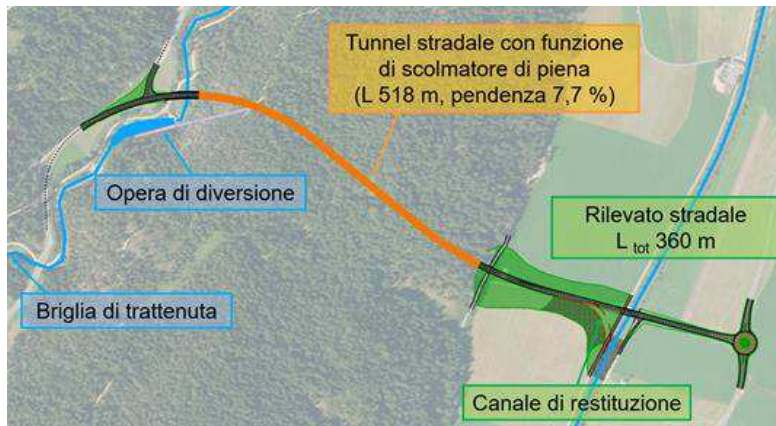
Localizzazione planimetria delle principali opere in progetto.
